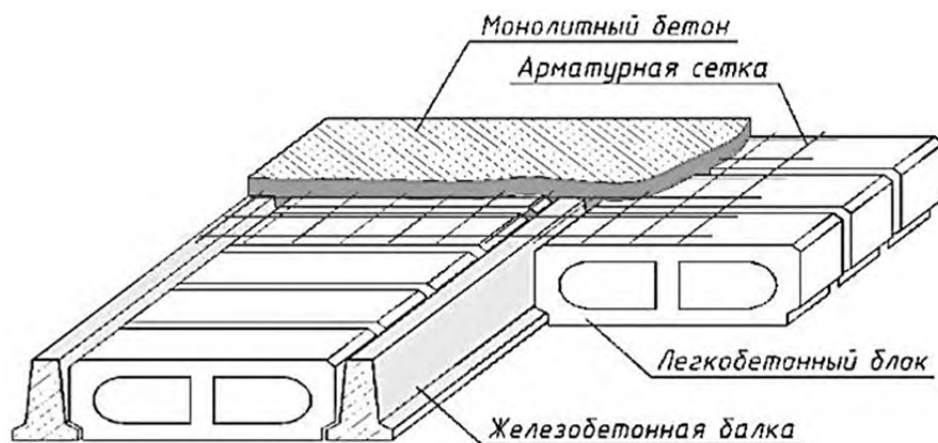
Конструкция сборно-монолитного перекрытия с железобетонными балками из мелкогабаритных элементов
